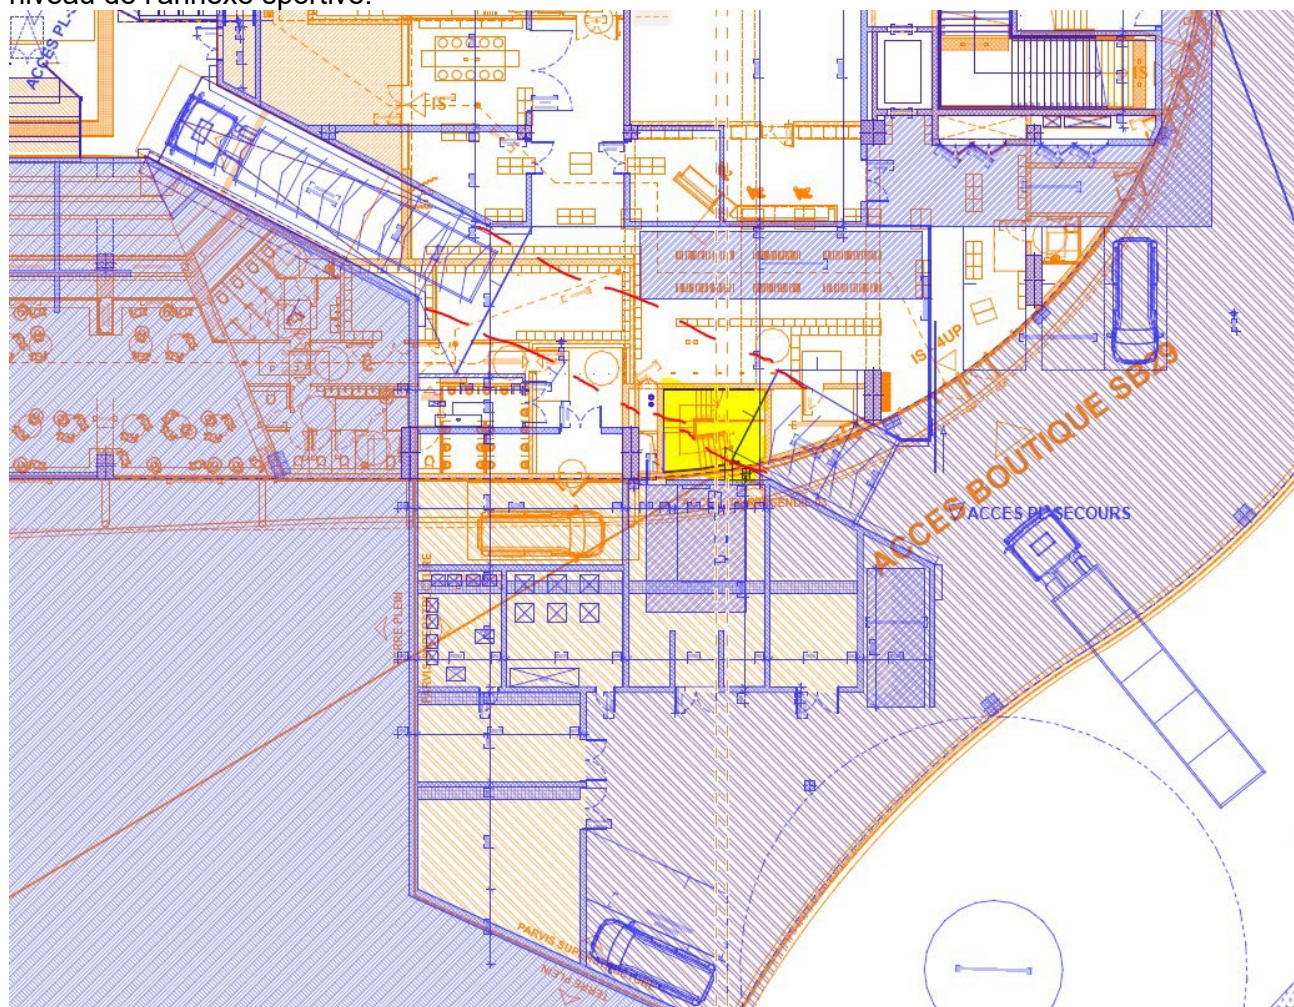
Superposition plan niveau parvis et plan annexe sportive
